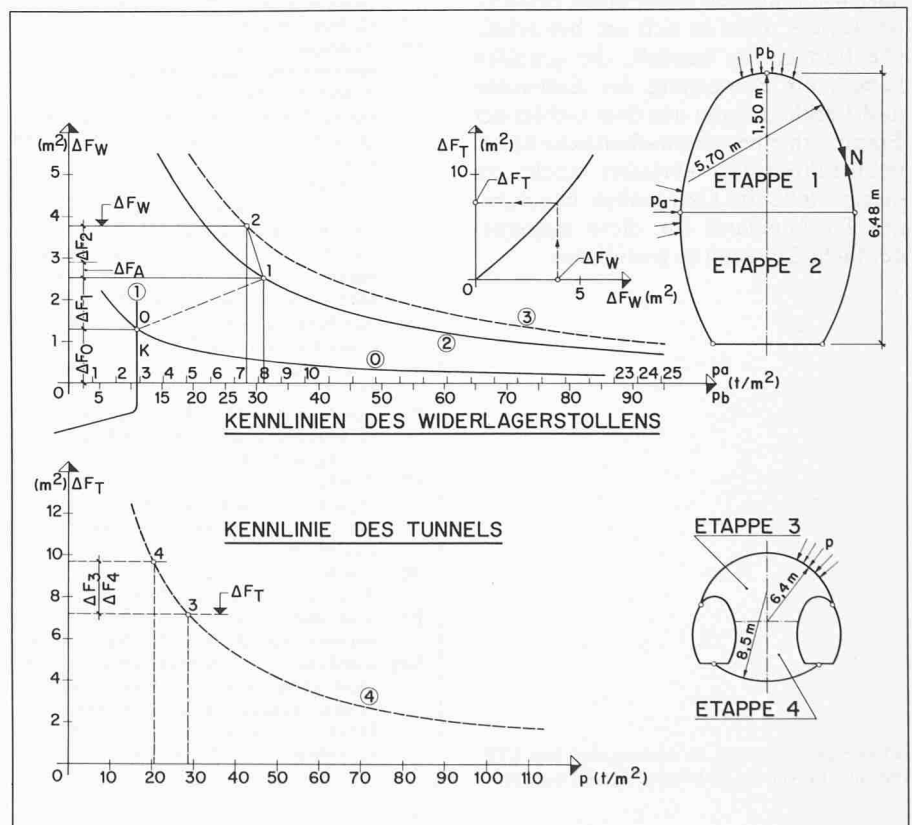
Nachgiebigkeit der Einbauten in den verschiedenen Bauetappen und Stabilisierungsdrücke.
